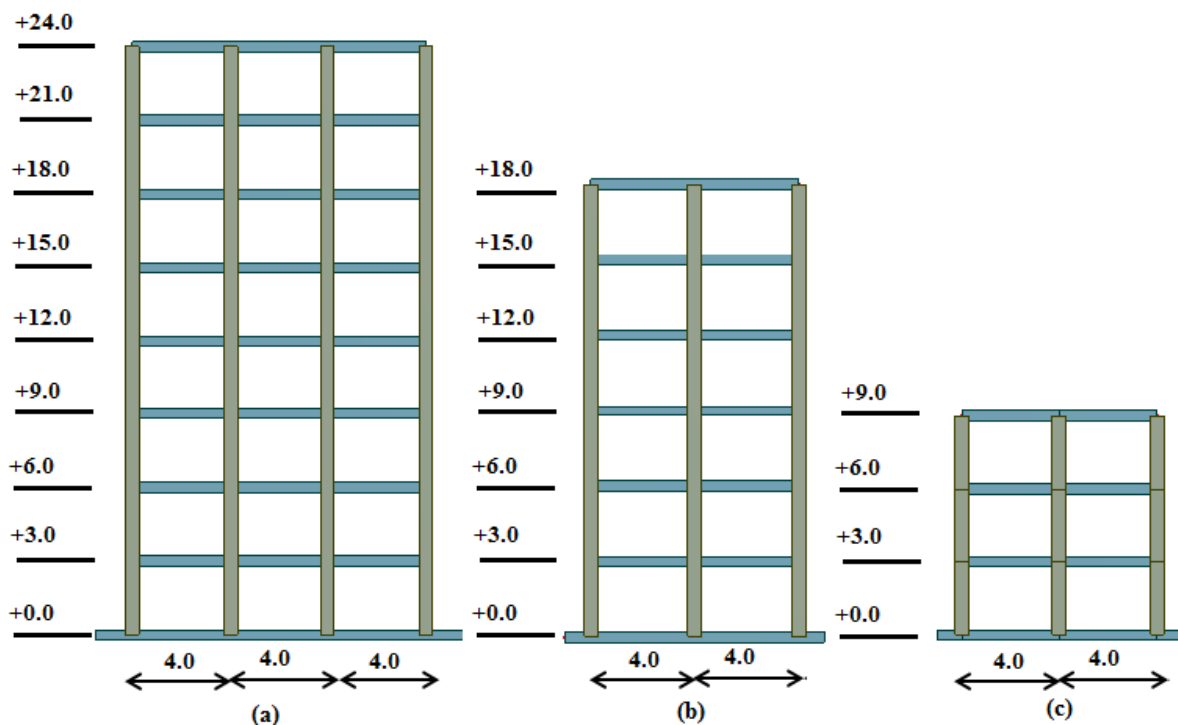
Vue en élévation avec dimensions des structures étudiées. (a) : 8 Niveaux (SP8), (b) : 6 Niveaux (SP6), (c) : 3 Niveaux (SP3).
